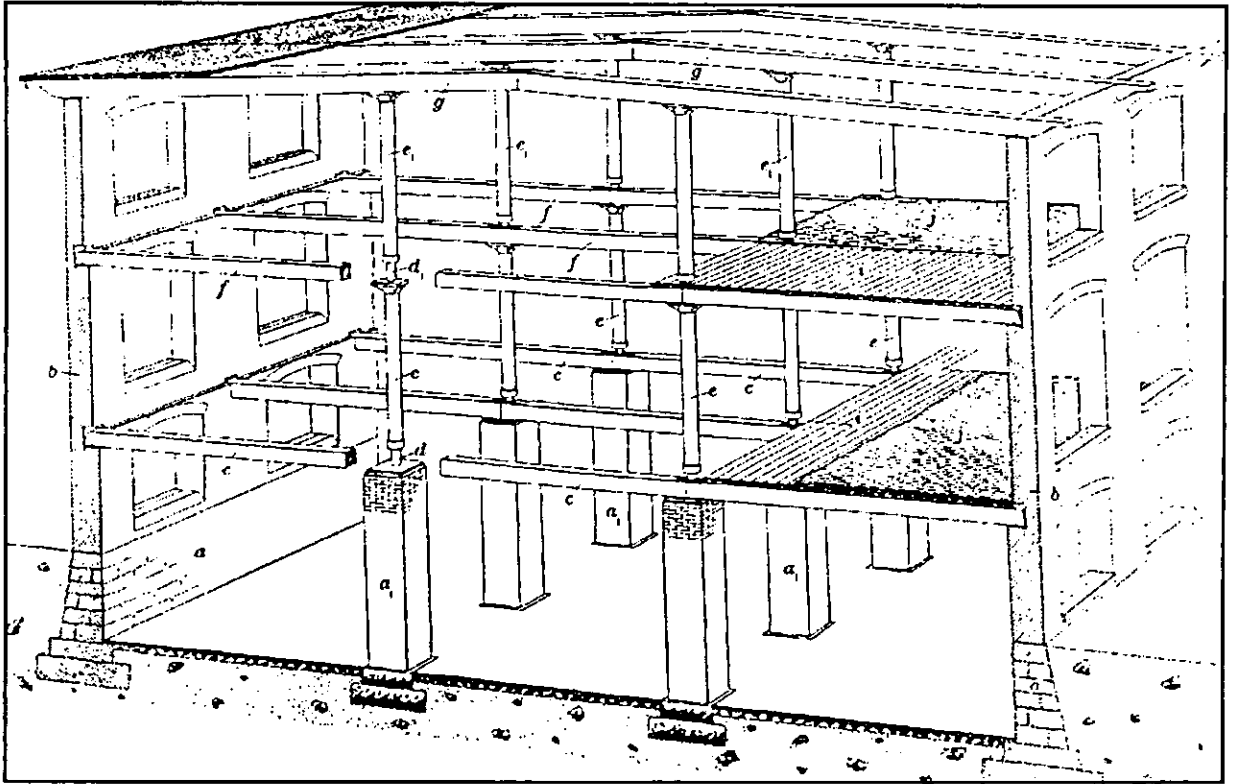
Un ejemplo de construcción de fábricas, alrededor de 1905 vista en corte de una fábrica con piso a prueba de fuego, dos filas de columnas de madera, la mampostería del edificio fue ancha, el techo casi plano y ventanas con arcos rebajados, las calles interiores son delgadas y a nivel.
